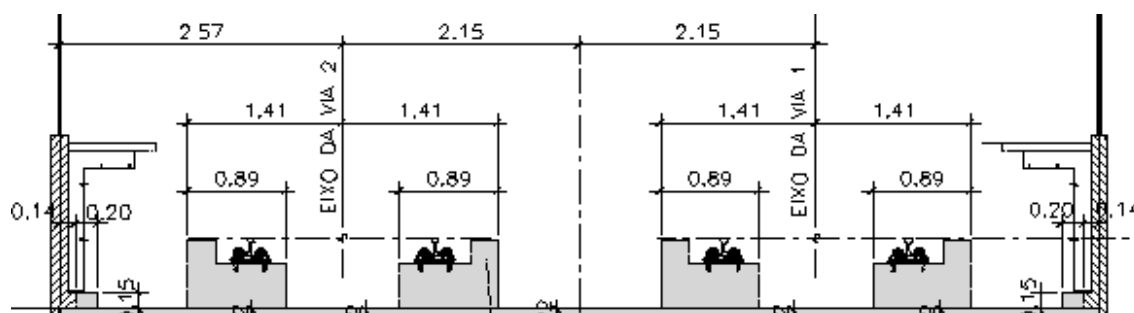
Superestrutura da Via Permanente – Fixação Direta.
